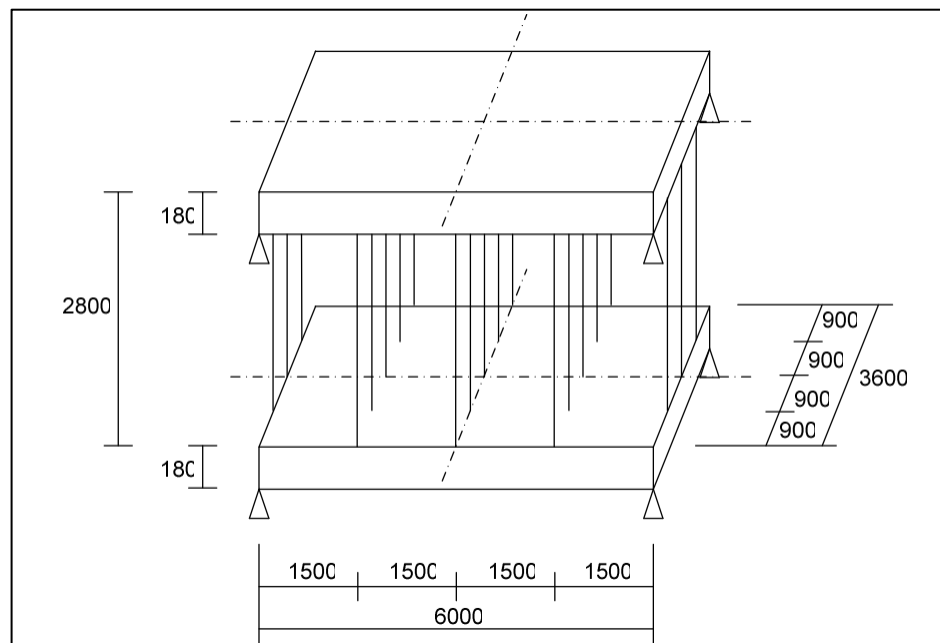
Dimensiones principales del ejemplo de Liu et al. (Dimensiones en mm) (Fuente: *Construction load analysis for concrete structures*, LIU et al. (1987))
